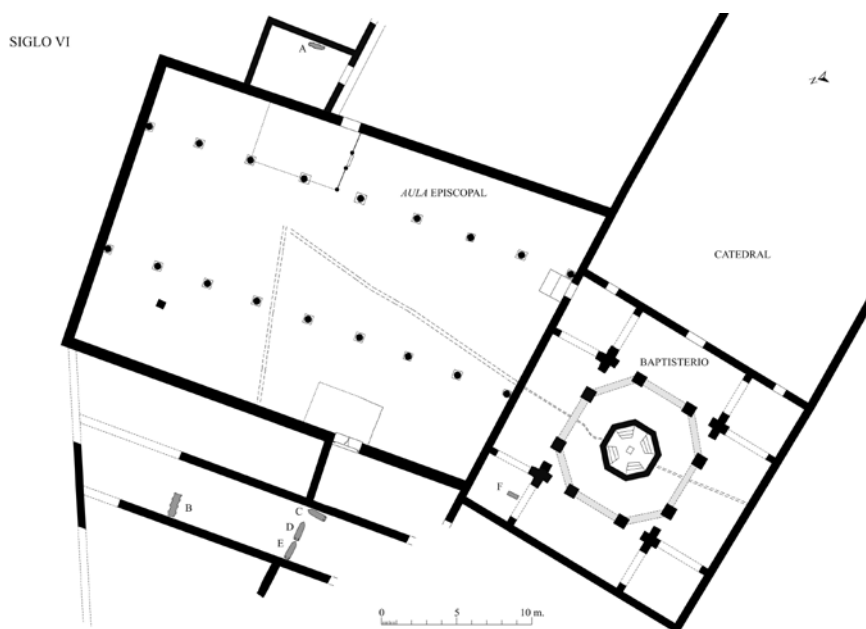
Planta del aula episcopal y del baptisterio con la indicación de los distintos enterramientos (a-f). Planimetría: E.Revilla-MHCB
